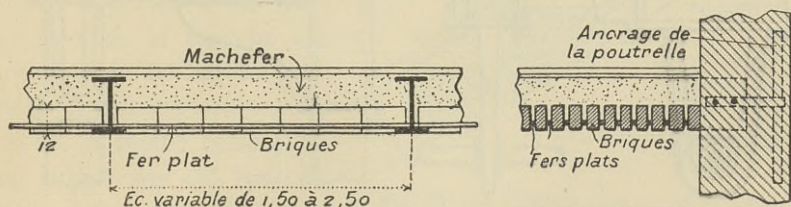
Plancher avec poutrelles en fer et remplissage en briques, système Klein.
